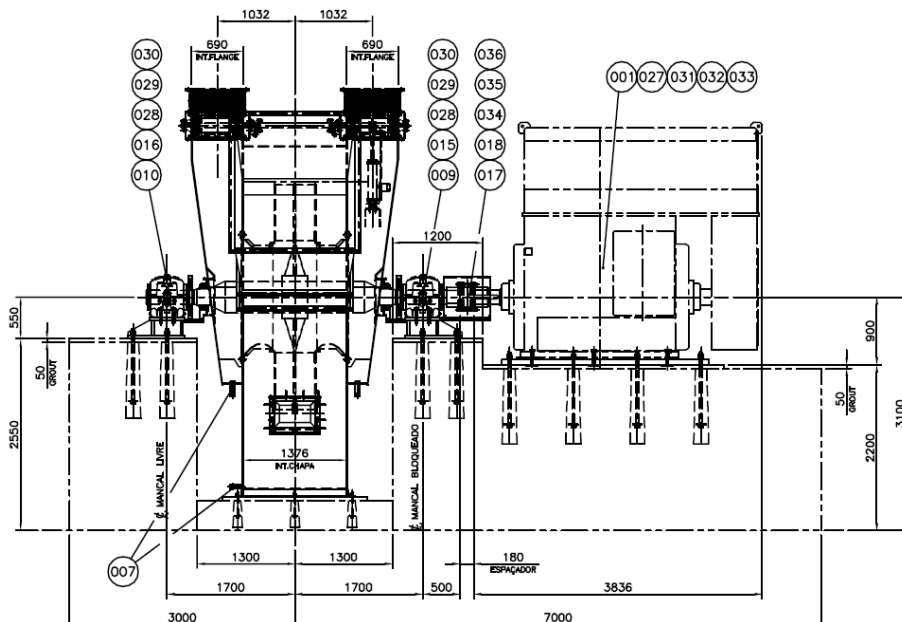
Corte longitudinal pelo eixo do soprador mostrando as bases de fixação do equipamento no bloco de concreto da fundação.
